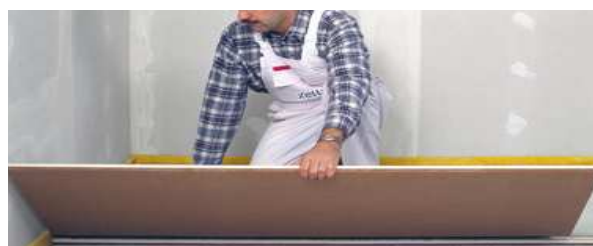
Pavimentazione a secco con pannelli in gessofibra
